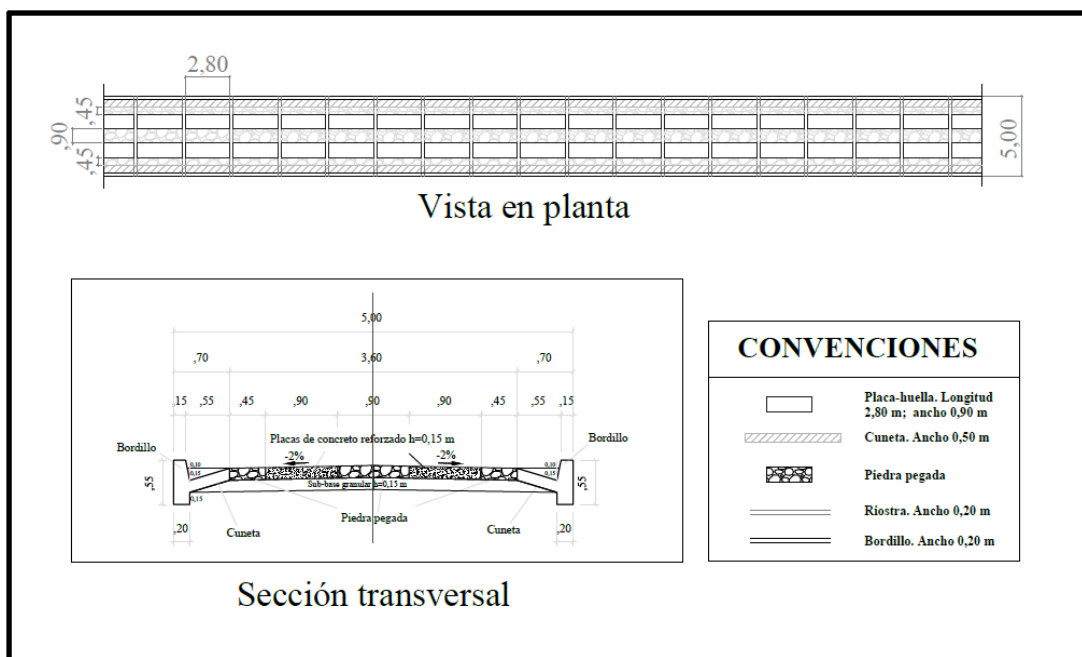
Vista en planta y el perfil de la sección transversal de su tangente
